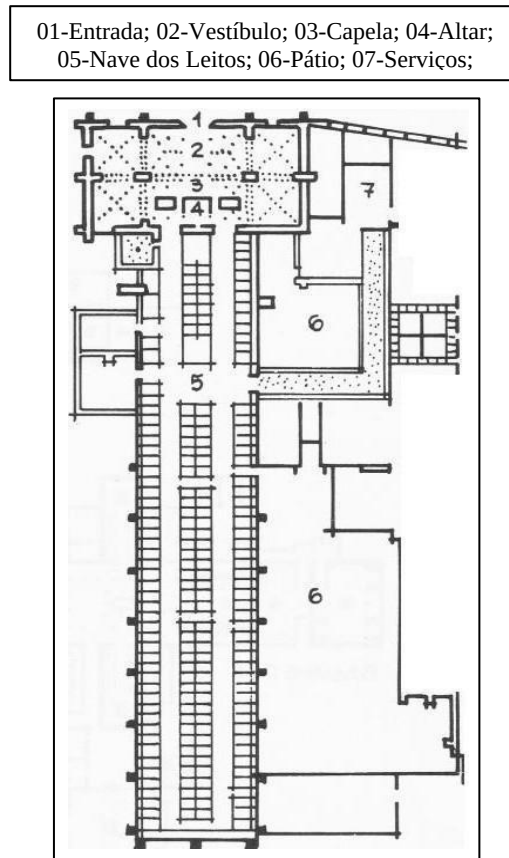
Desenho esquemático planta baixa da tipologia da Nave.
